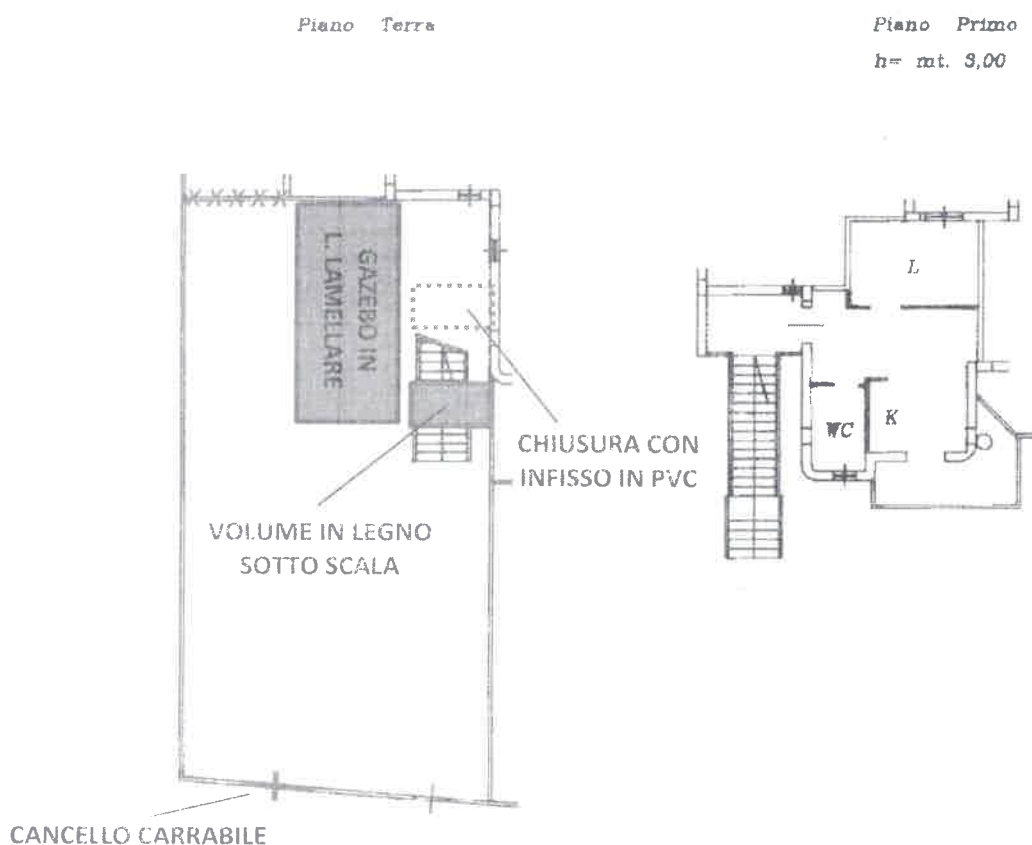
Pianta come da rilievo (in rosso le modifiche).
